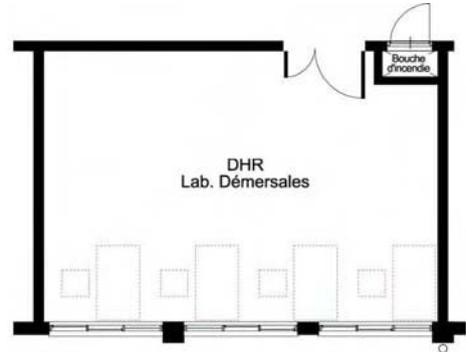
Plan du Lab. Prospection Ressources Démersales
